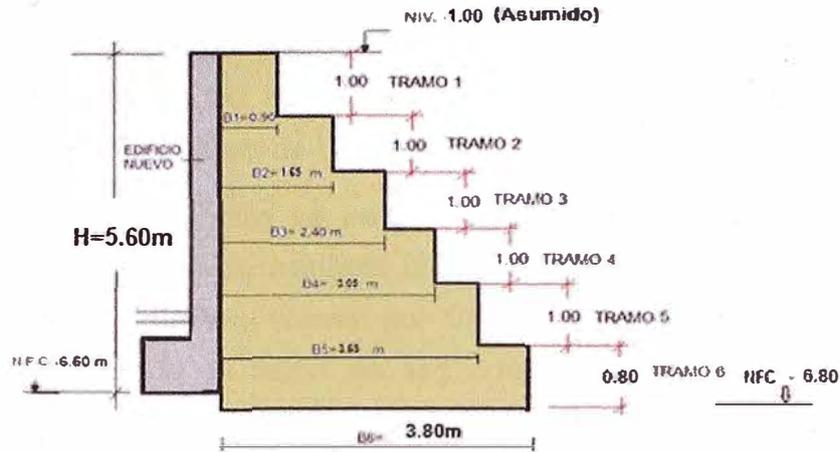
Diseño final de calzaduras (Sección 2-2)
